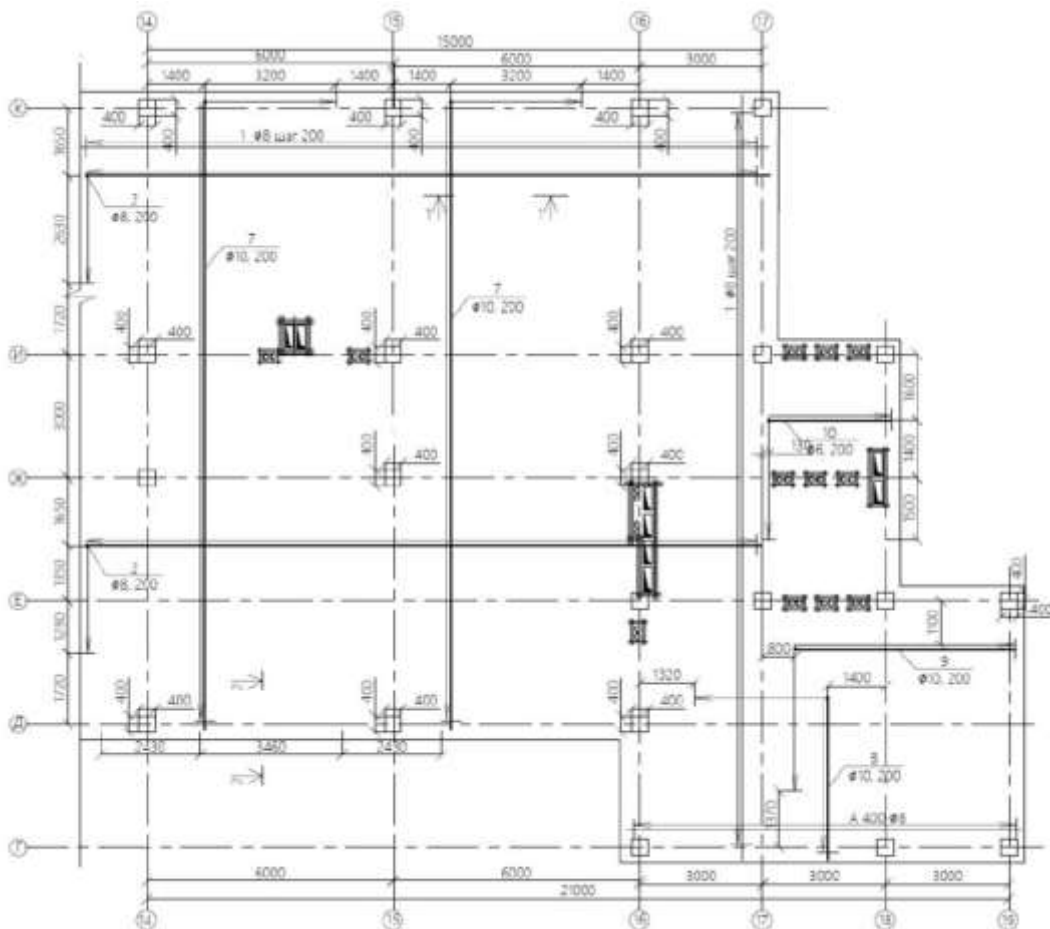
Схема нижнього армування монолітної плити перекриття.
